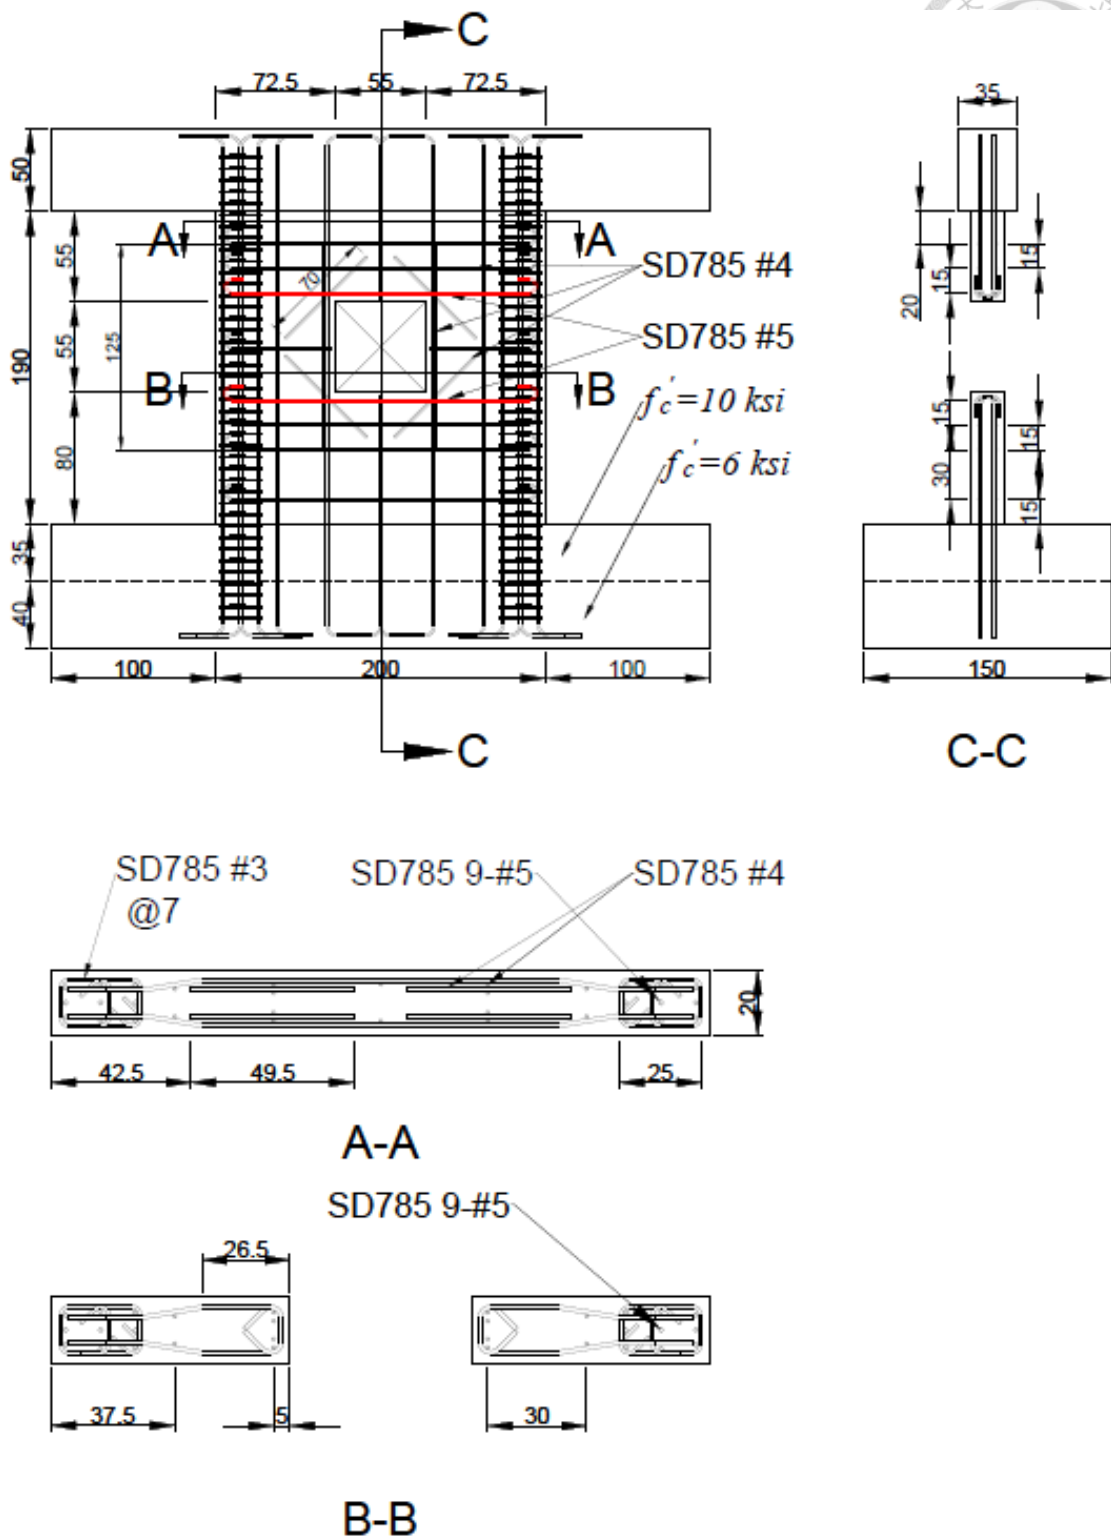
試體 WO 配筋圖 (Unit: cm)
